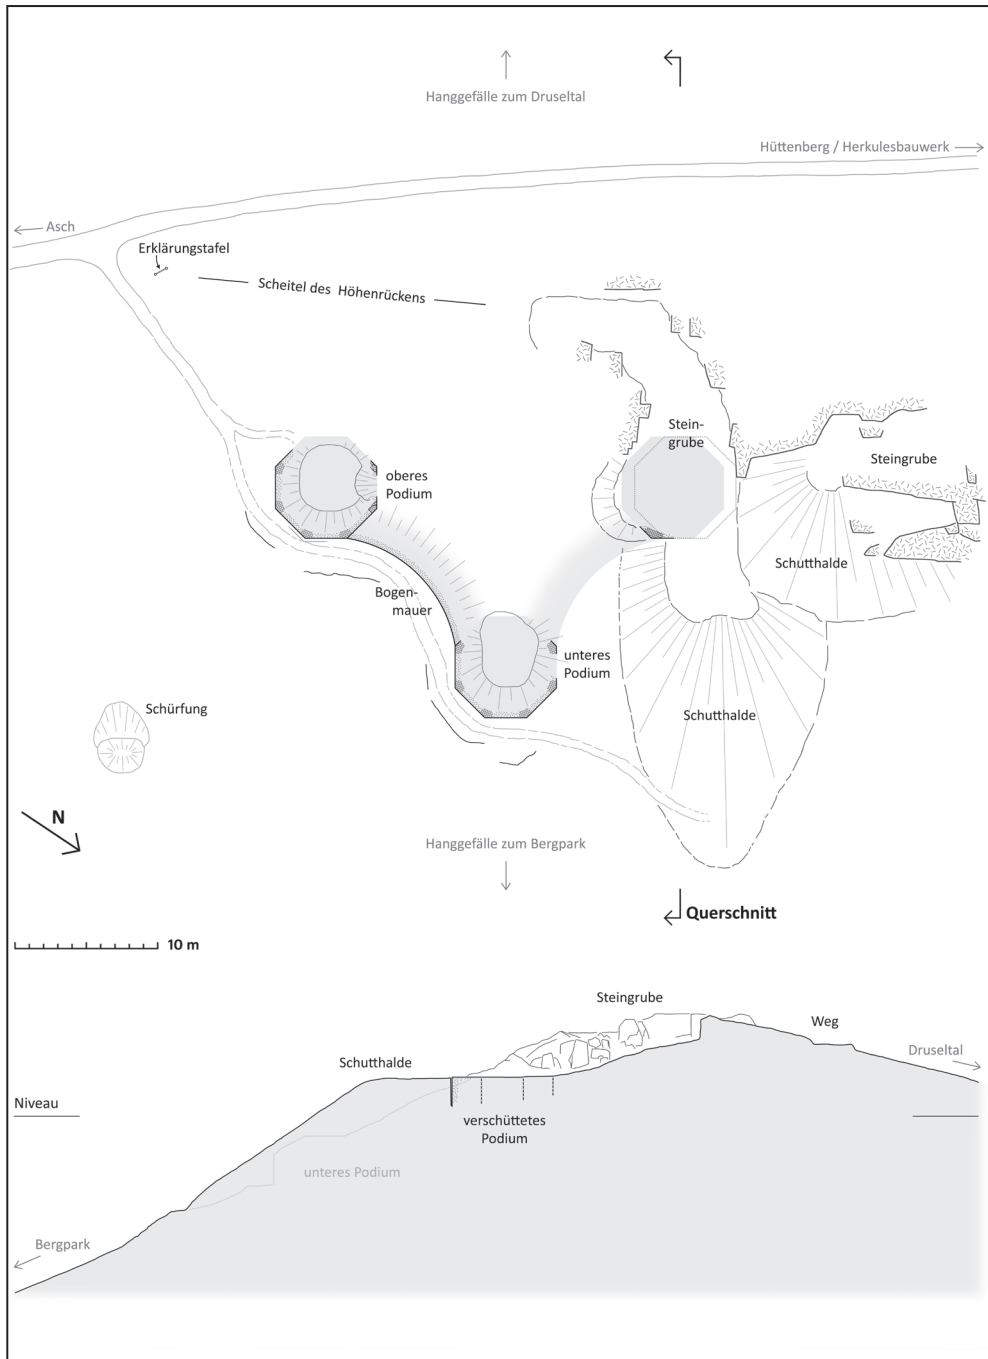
Grundrissplan und Querschnitt mit Rekonstruktion des in der Steingrube verschütteten Achtecks; die spiegelbildlich zu erwartende Lage ist im Grundriss gepunktet dargestellt [Plan Stefan King]
